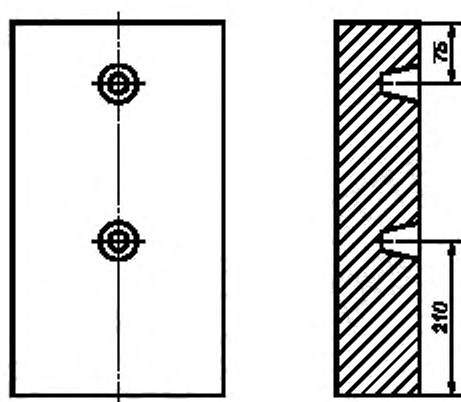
Размеры отверстий для штырей. Вариант 5
